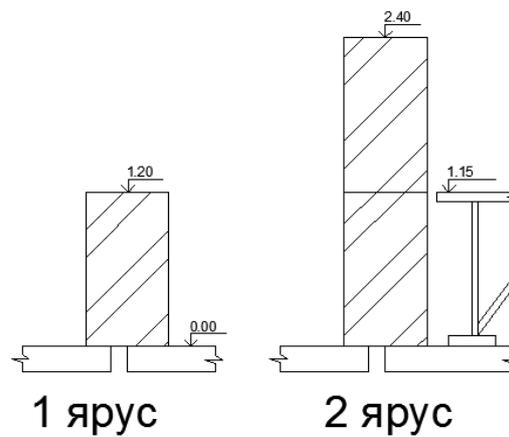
Схема разбивки кладки первого этажа на ярусы.
